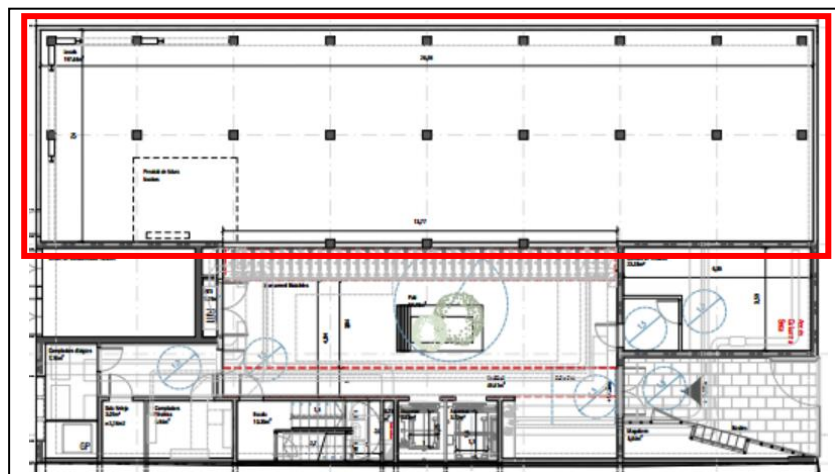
Ubicación en planta baja del recinto emisor del ensayo ACU-24-119841 (24).
